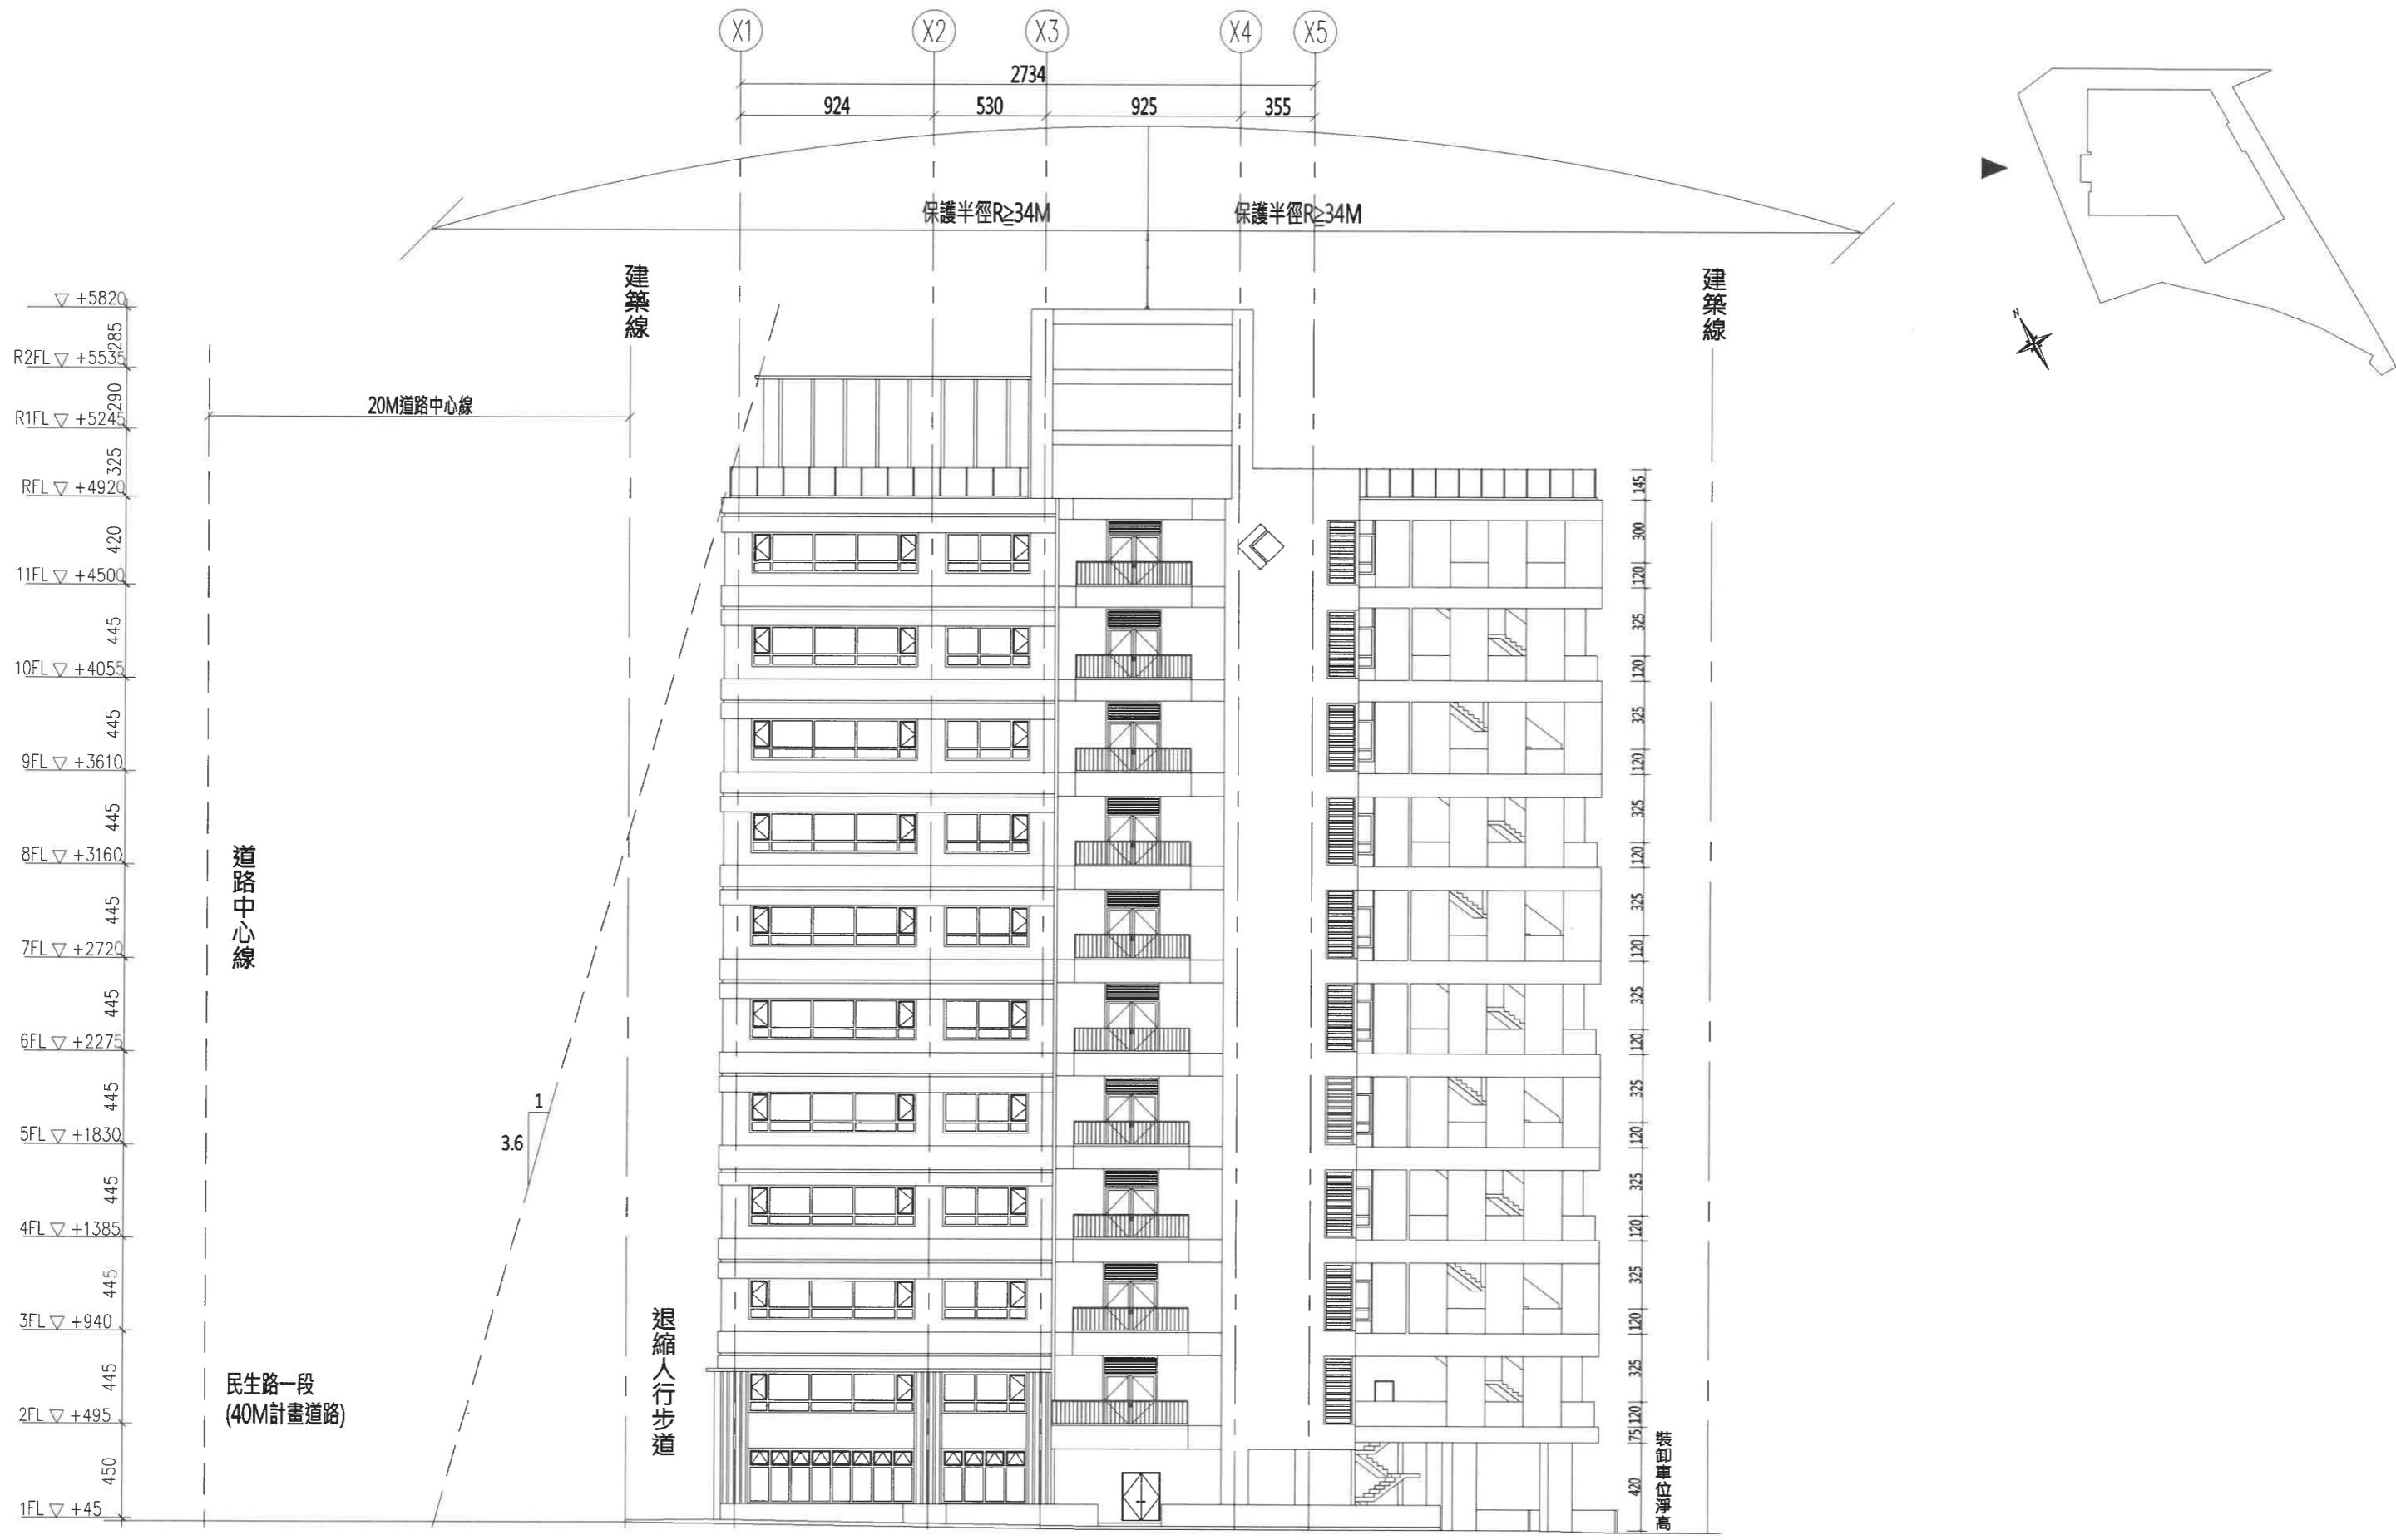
西北向立面圖(維持原核定)(S : 1/300)
